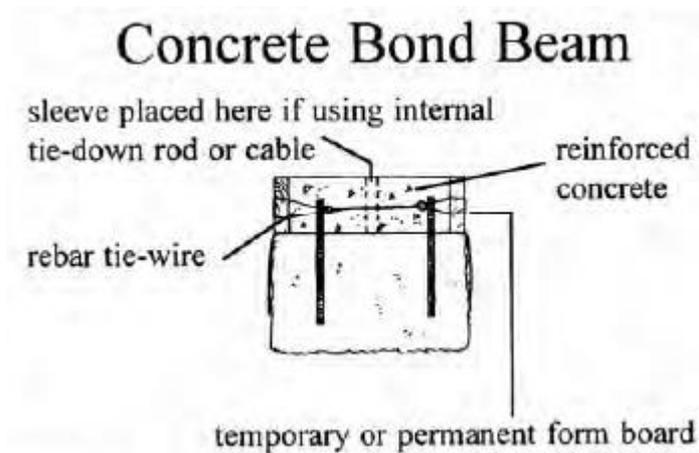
Esquema da Fixação na Estrutura de Concreto
